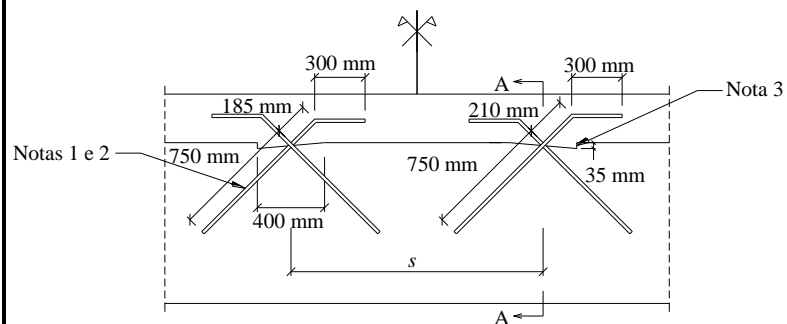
Secção longitudinal do sistema de ligação.
